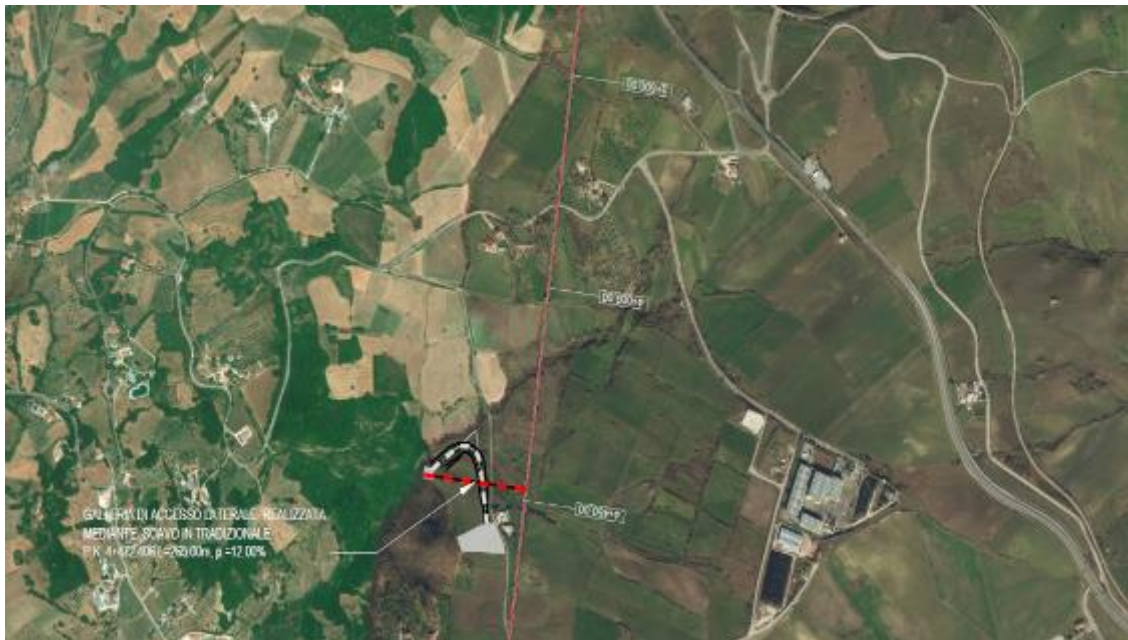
Estratto Planimetria tracciato di Galleria – galleria di accesso laterale
